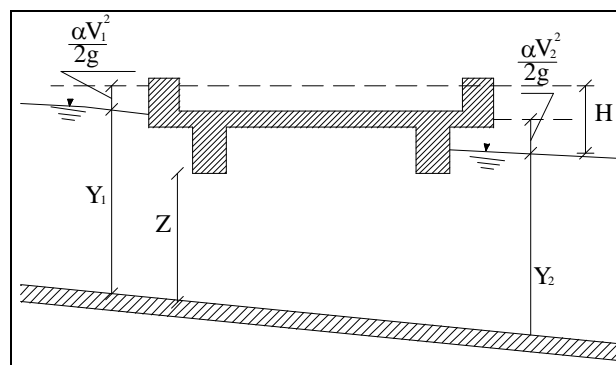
Sezione schematica di un ponte – Schema di calcolo
